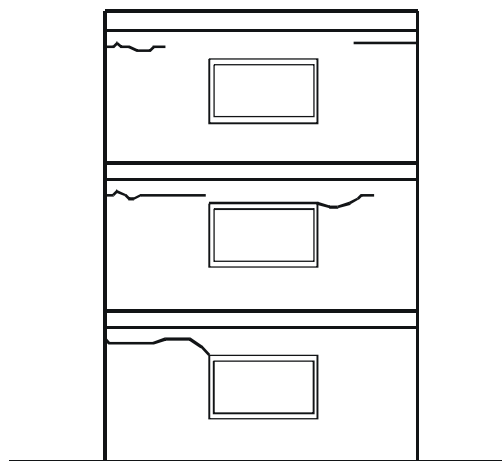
fissuras horizontais em paredes por retração de lajes intermediárias (THOMAZ, 1989)
